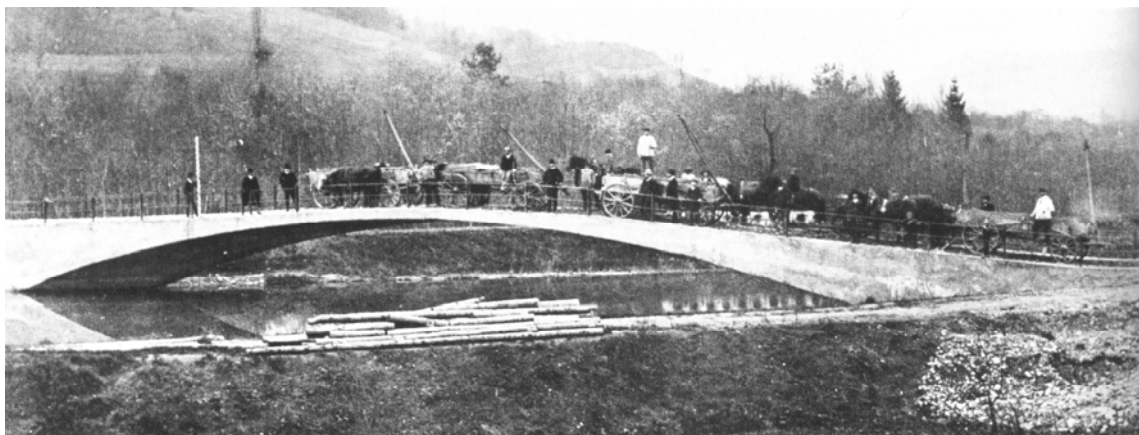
Erste Eisenbetonbrücke der Schweiz, Wildegg, 1890
